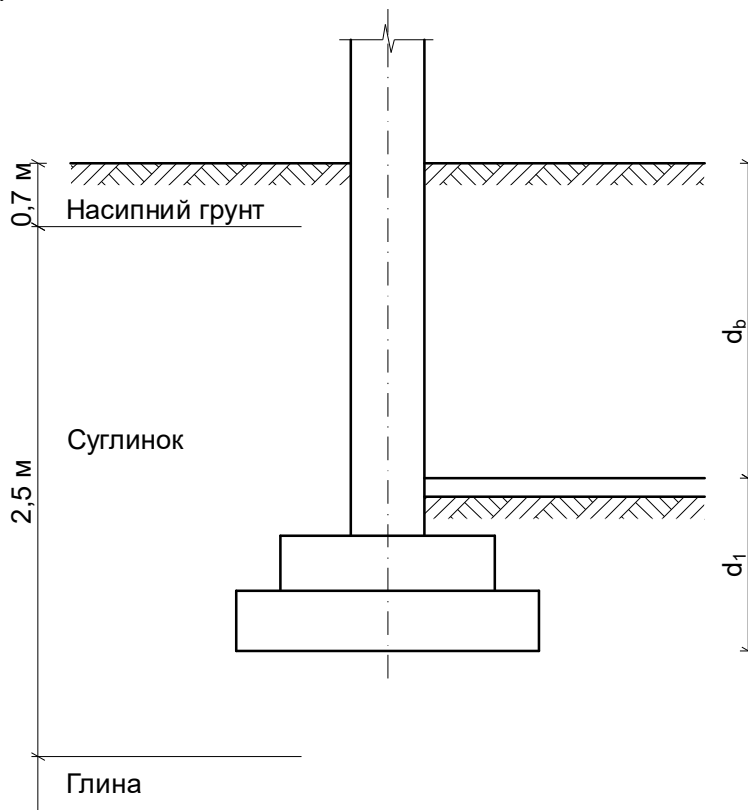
Схема розміщення фундаменту у ґрунті
